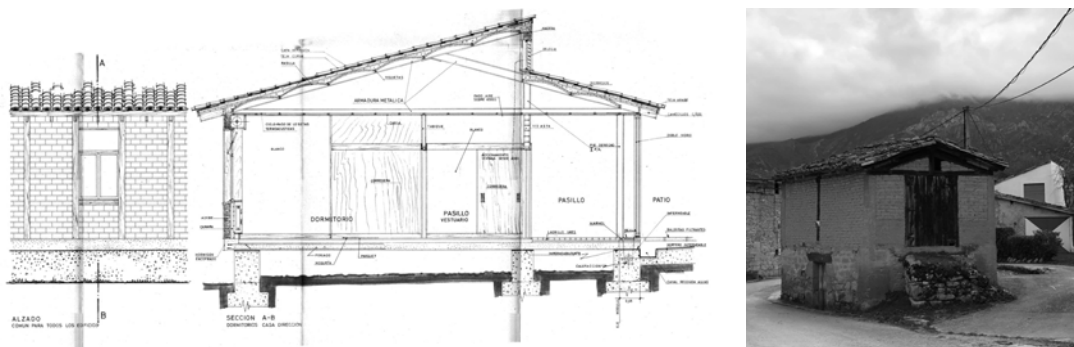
(a) Detalle constructivo. (b) Construcción tradicional en Santa María de Garoña (2019).
